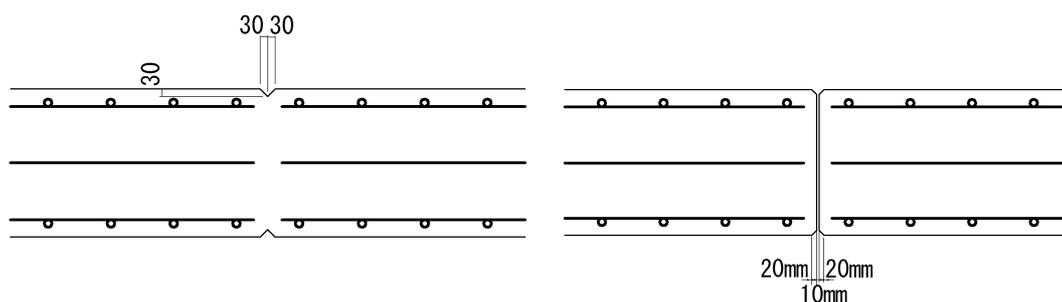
ひび割れ誘発目地形状(平面図) 図 2-50 伸縮目地の形状(平面図)
